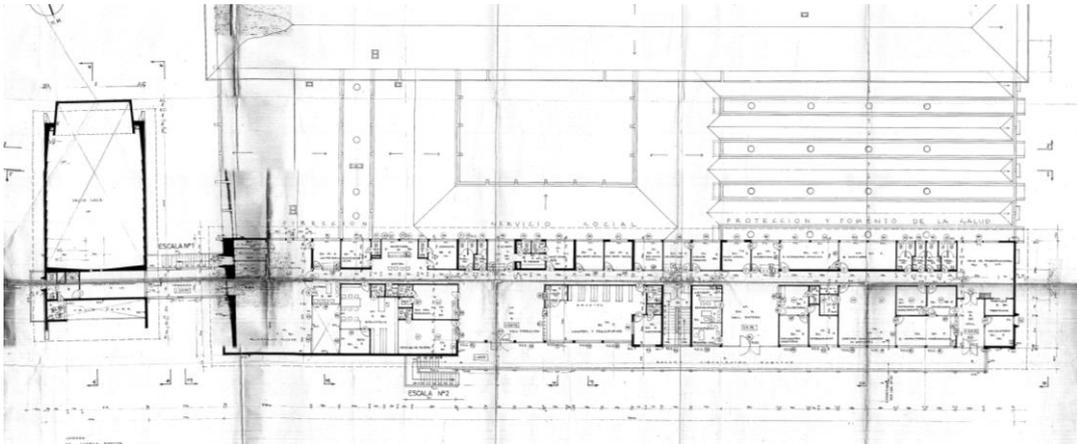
Planta Monoblock de hospitalización, 1967
